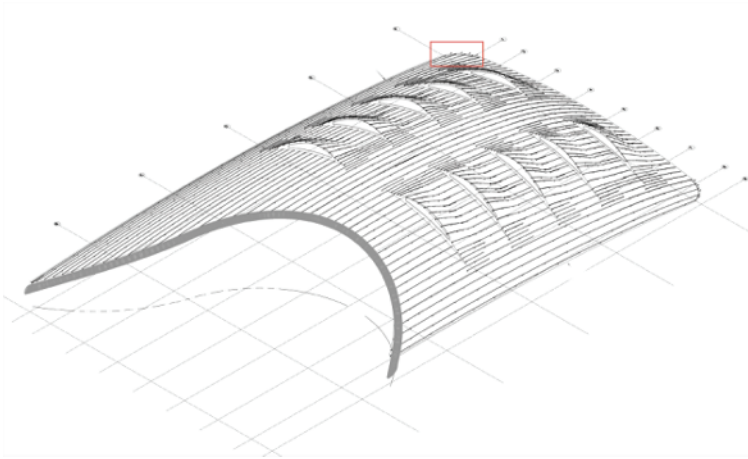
Aluminiumhülle, Stahlunterkonstruktion
